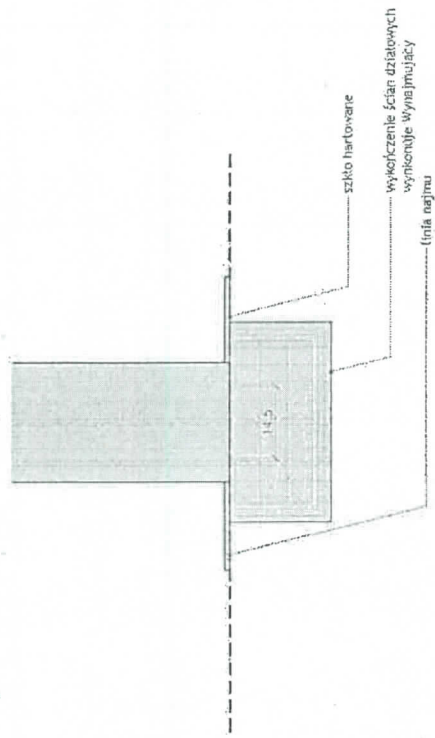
rzut detalu wykończenia ścianek działowych - hydrant
